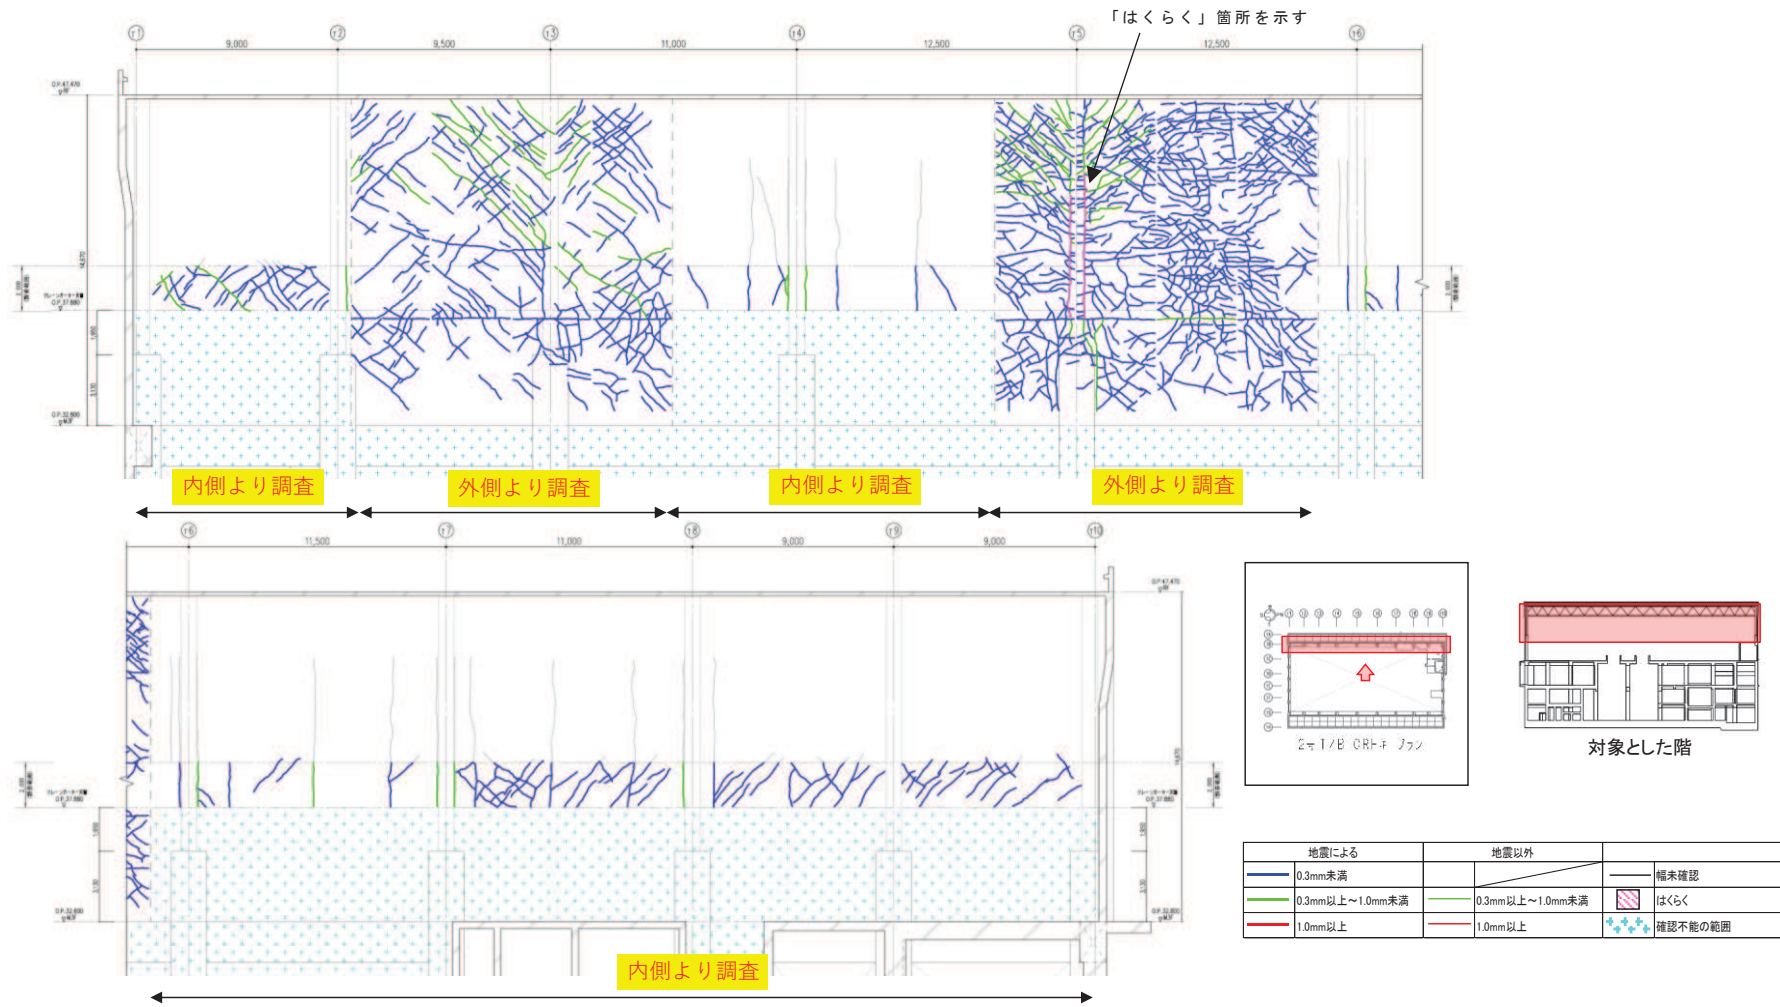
タービン建屋のひび割れ分布 耐震壁 (53) クレーン階 TB 通り
